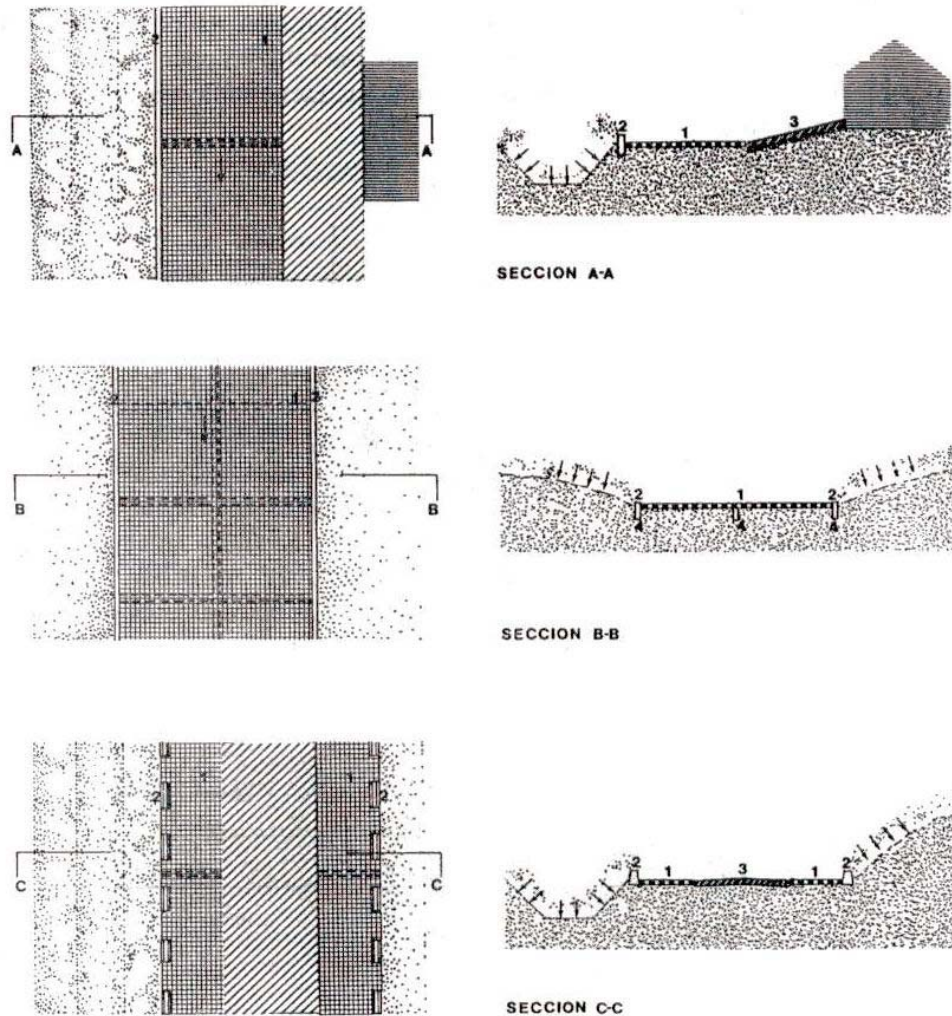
Ejemplos de disposiciones difusas de pavimentos celulares en estacionamientos. 1.- Estacionamientos o pavimento celular, 2.- Soleras o zarpas de confinamiento, 3.- Superficie impermeable.
